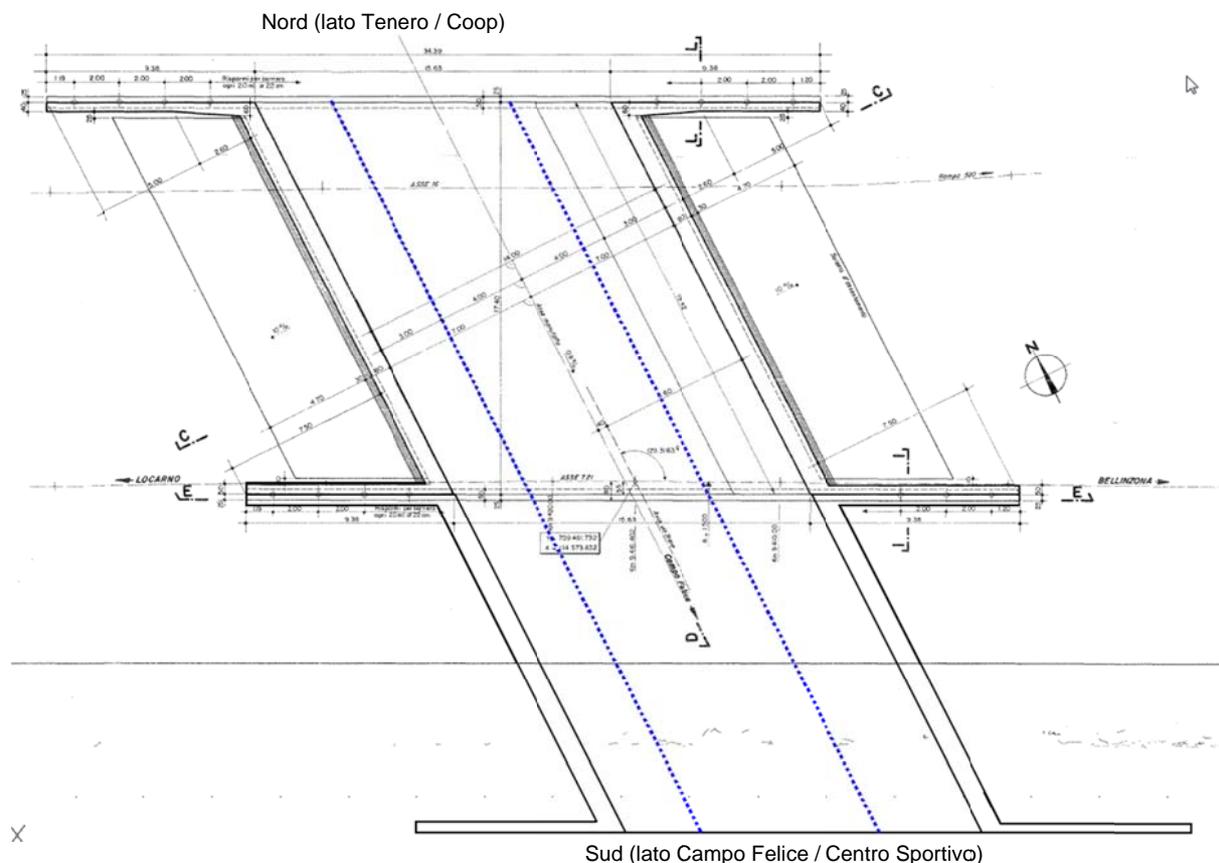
Planimetria sottopasso via Brere esistente sotto A13
